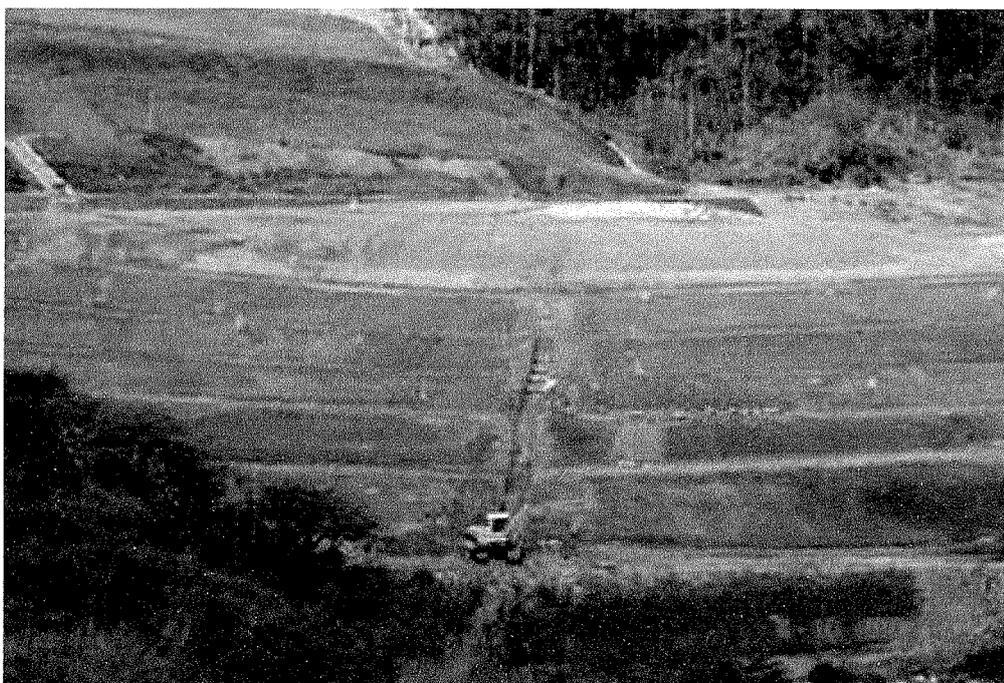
Plantio de Gramíneas e Drenagem Pluvial nos Taludes Definitivos do Aterro Sanitário
